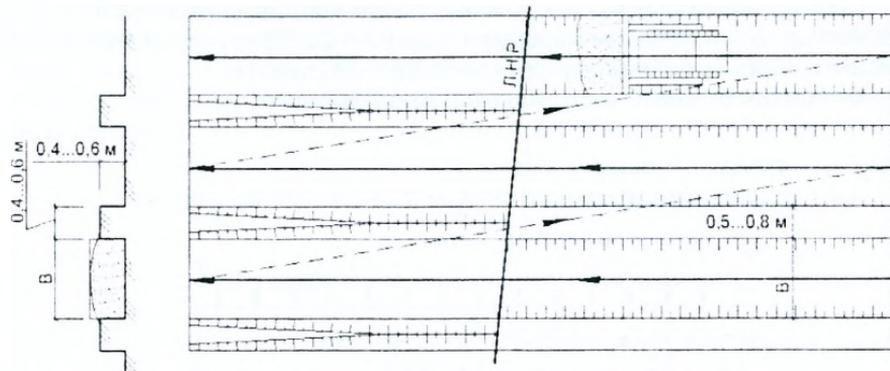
Ярусно-траншейная схема разработки и перемещения грунта бульдозером
